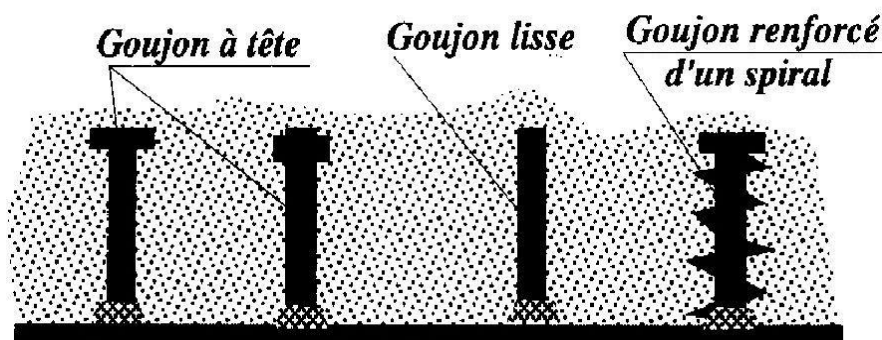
Différents types de goujons – avec ou sans tête, lisses ou renforcés- soudés sur la semelle supérieure de la poutre métallique.
